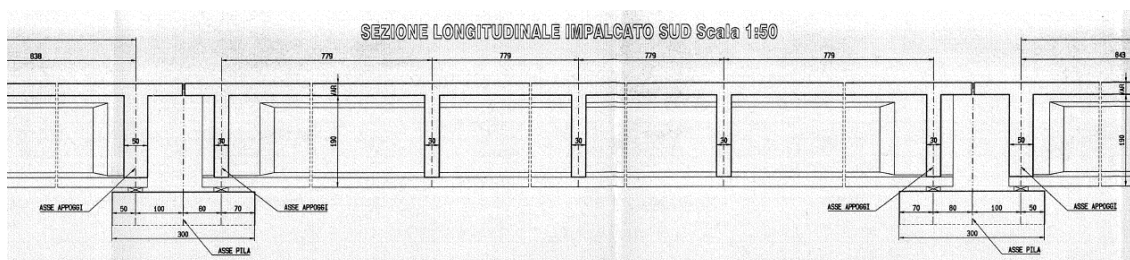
Ponte sul torrente Mavigliano, sezione longitudinale campata 2 [010.pdf]
